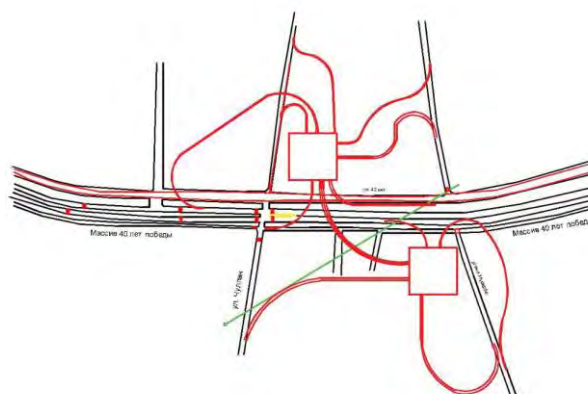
Генеральный план с координатами точек строительства тоннеля
